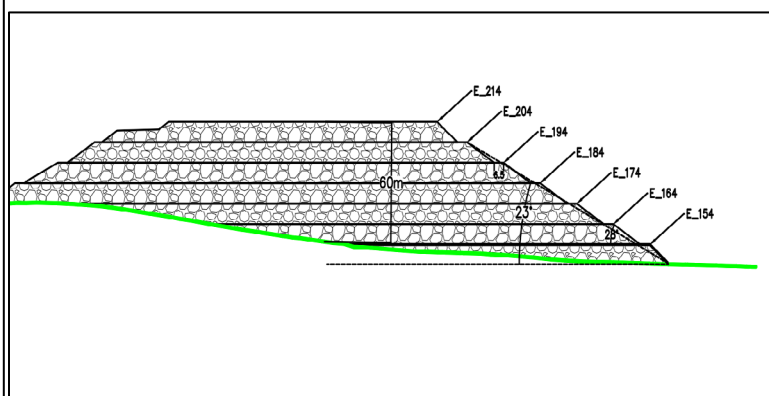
Šema odlaganja i planiranja istovarenog materijala
